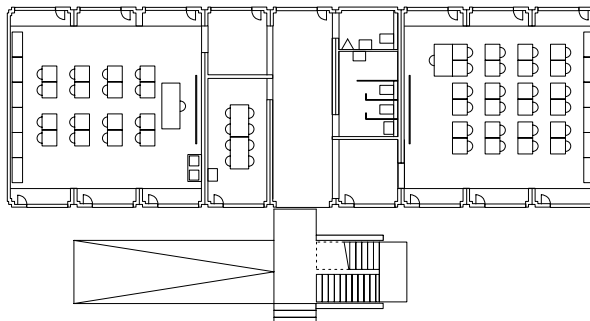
Züri-Modular, photo et plan / Bauart Architekten und Planer AG
